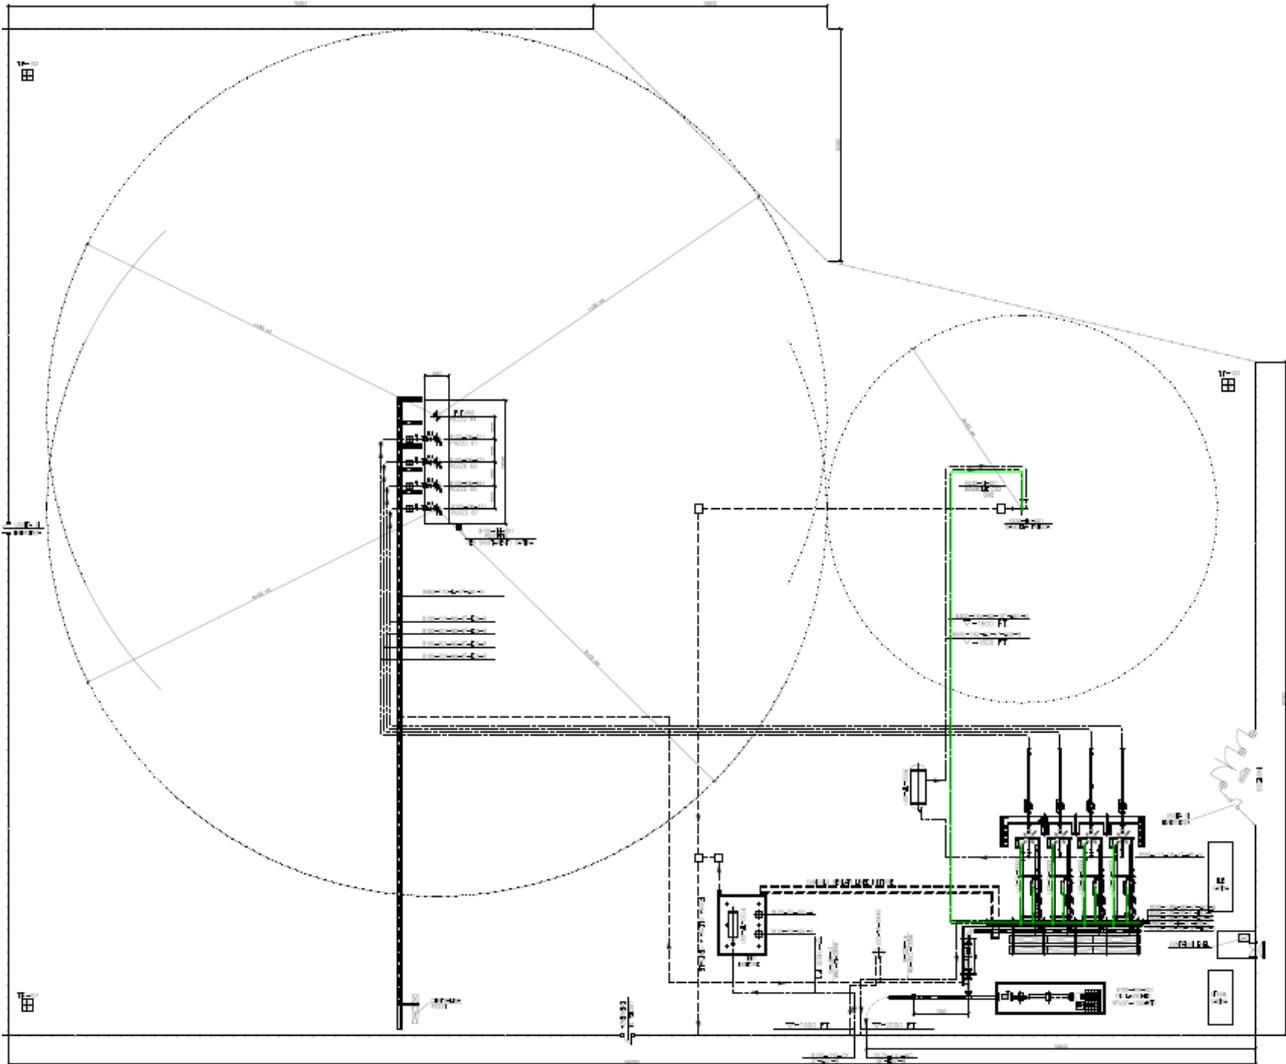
Planimetria andamento tubazioni- Collettore per BDV e PSV
